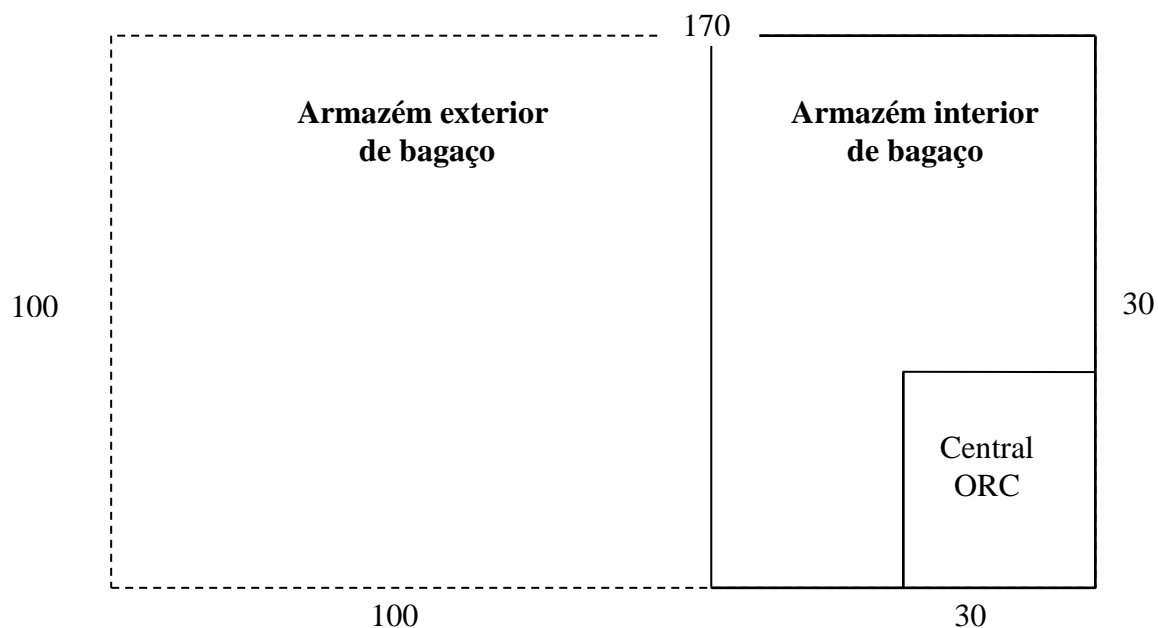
Planta com as áreas de implantação da central de biomassa, para ORC.
